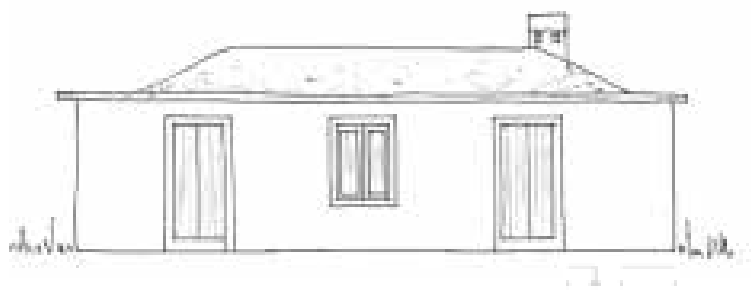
Fachada da casa de salão com cobertura de 4 águas. (Ilustração nossa, 2016).'
